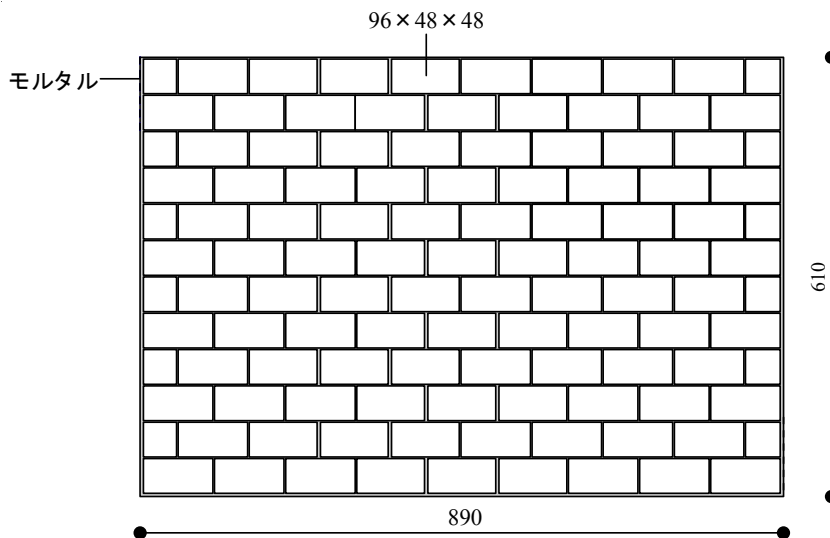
無架構コンクリートブロック造壁 (IW) 試験体の詳細図 (単位 : mm)
